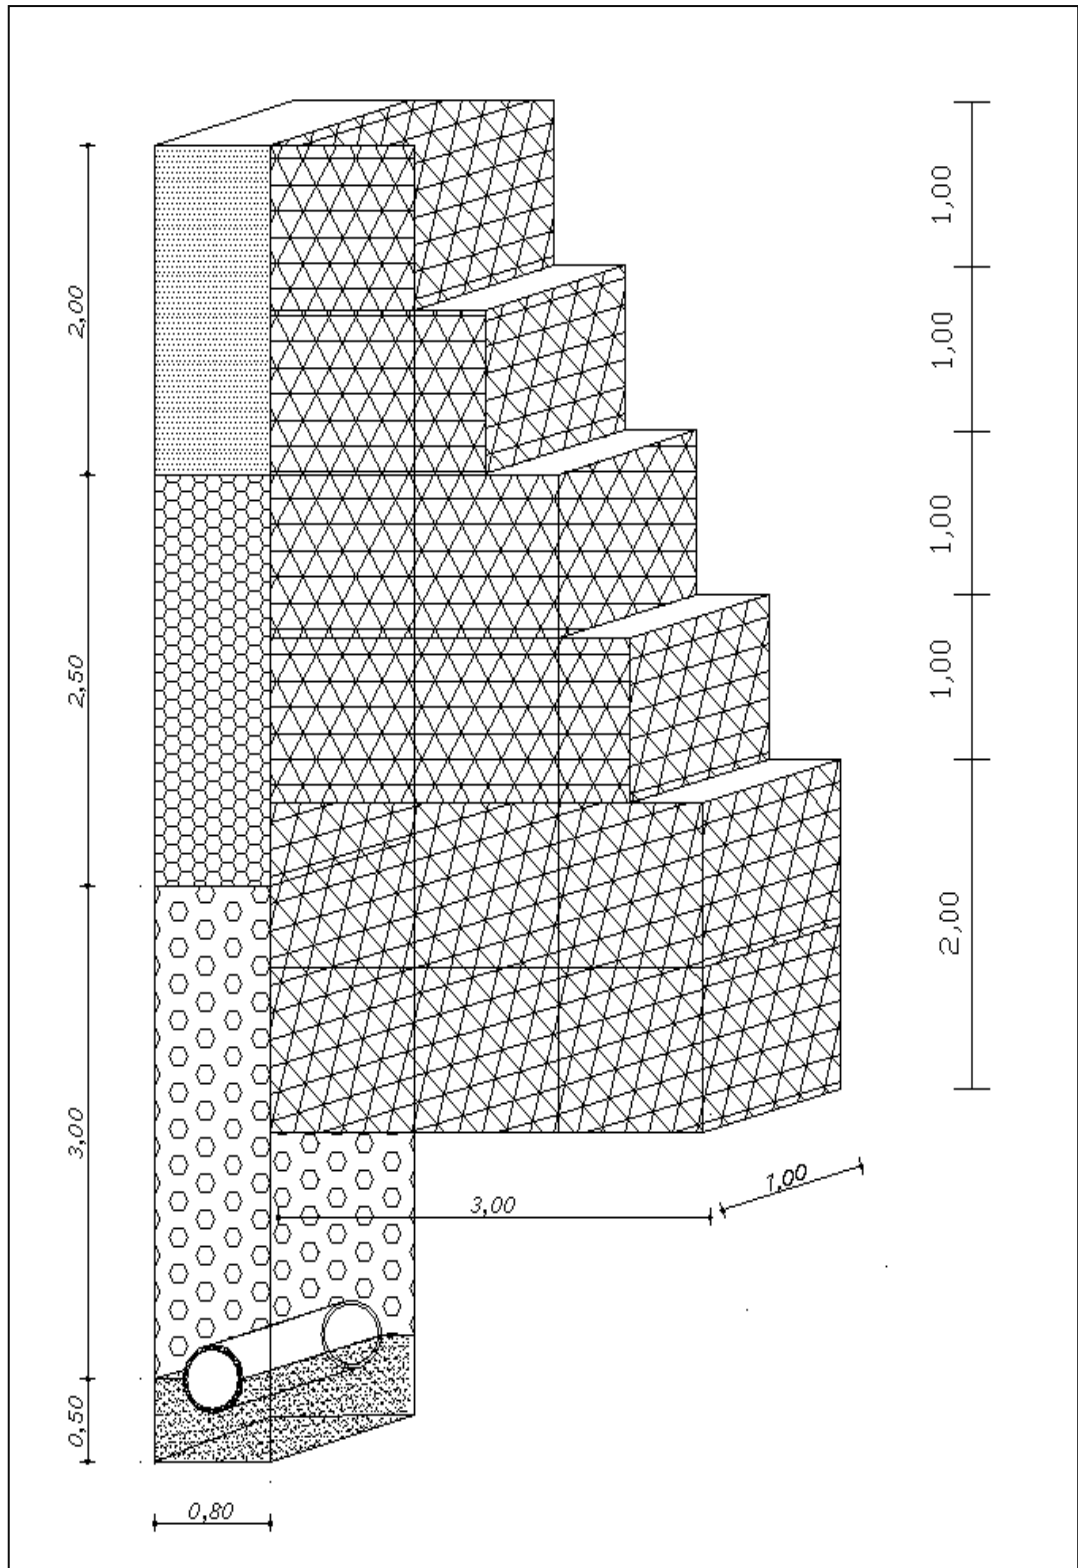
Gavión tipo caja armado adyacente a la pantalla de drenaje subterráneo.
